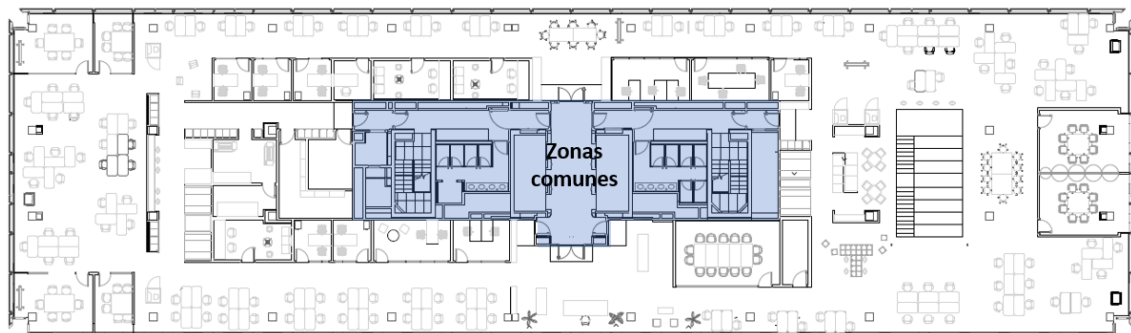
Planos distribución espacios por planta (3ª a 7ª)
